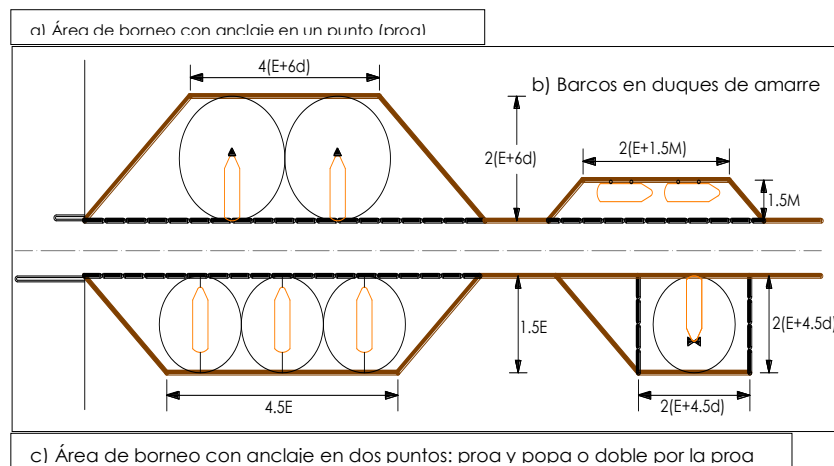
Dimensiones recomendadas para las áreas de fondeo interior
